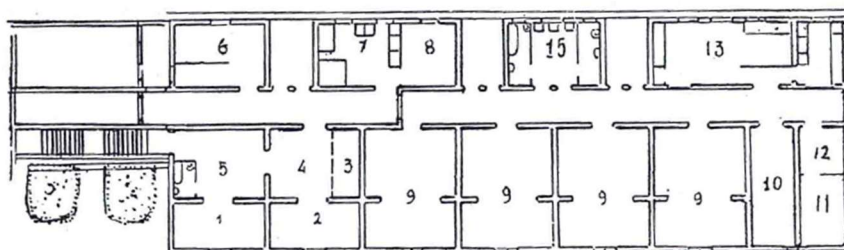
<sup>a</sup>. — Pianta del padiglione gestanti: piano terreno.
